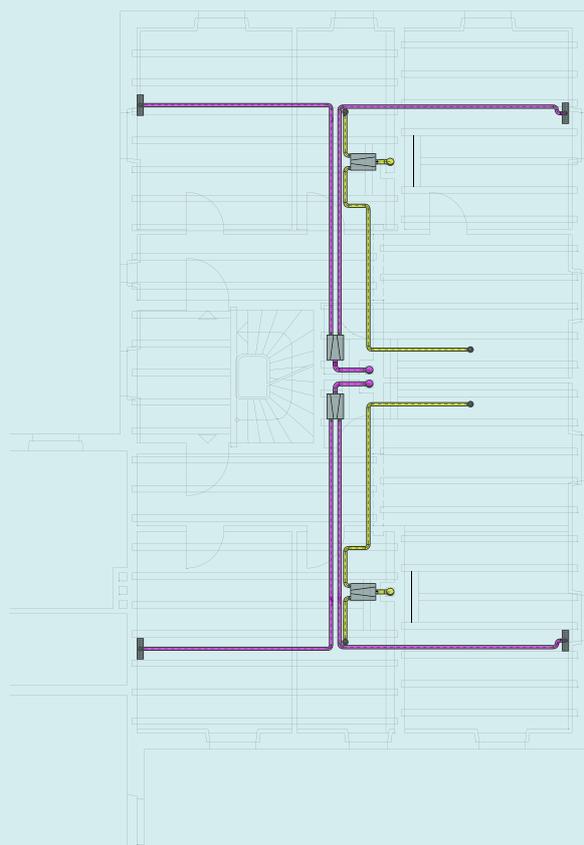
Grundriss Erdgeschoss – Balkenlage
